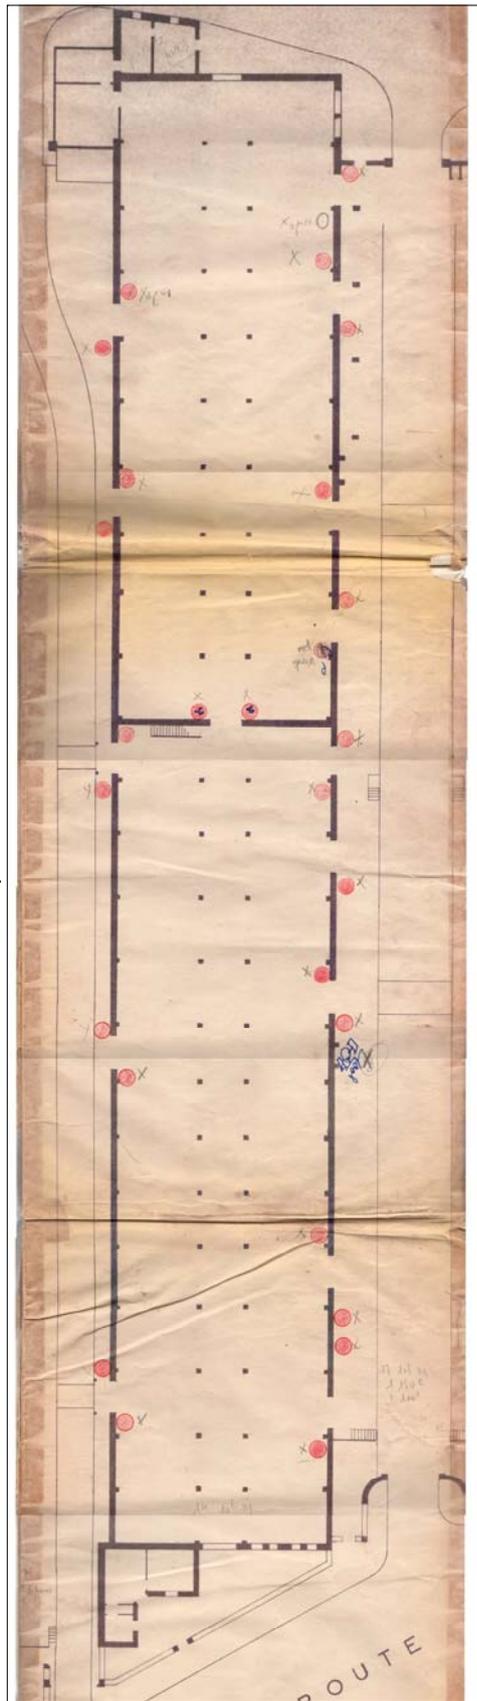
Usine TABACOOP- Bâtiment 1- Dock 3-structure poteau-poutre en béton armé- rez-de-chaussée- état actuel. Source: Auteur.
